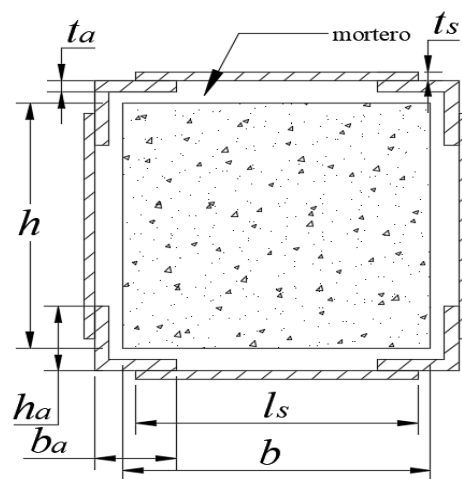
Sección transversal de columna encamisada con ángulos y soleras
